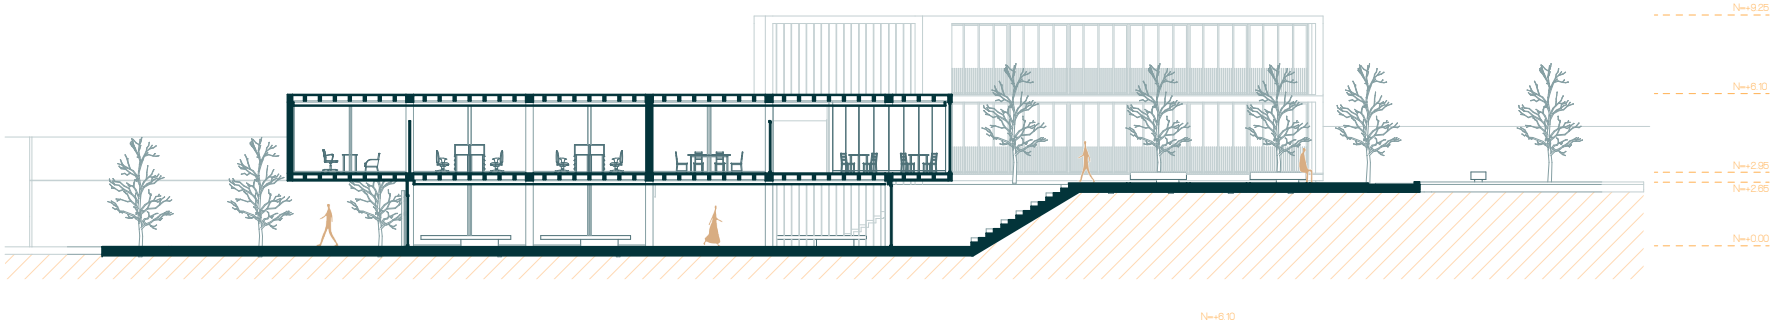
Sección A-A, Bloque A (Autores, 2023)
